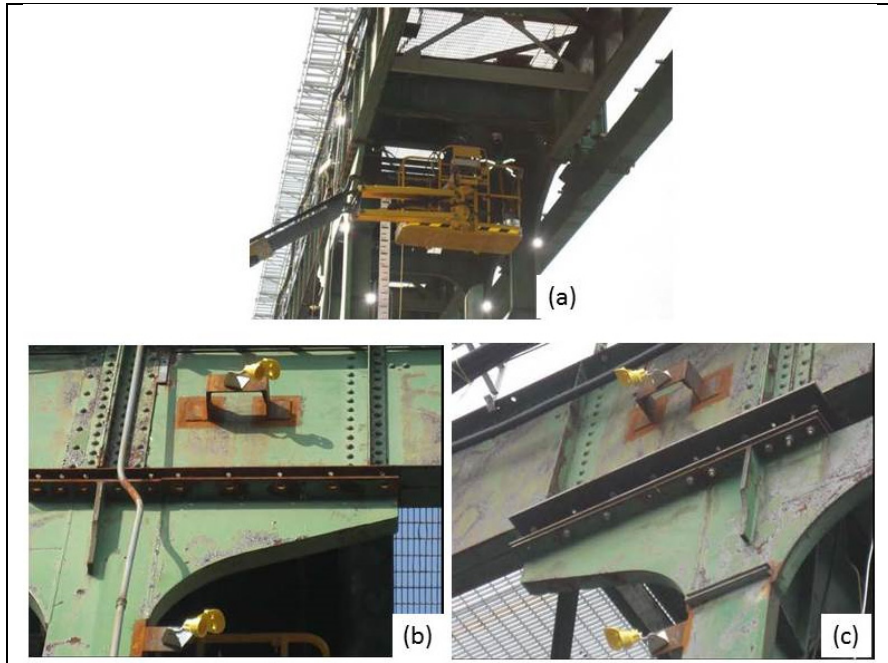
La Tuque hoist supporting structure: bridge or beam supports
